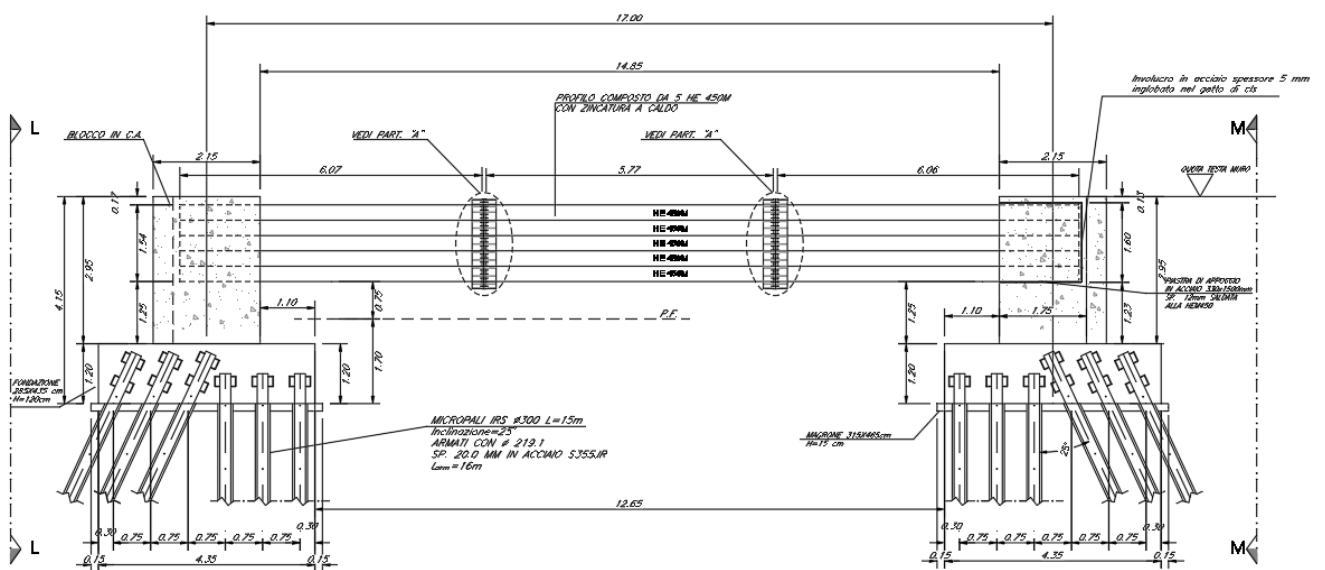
14: MU03 - prospetto generale muro opera di protezione con luce asse-asse di 17.00 m.
